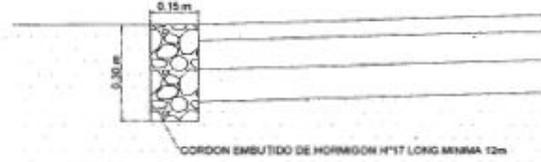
Detalle de Cordón Protector de Borde de Pavimento
